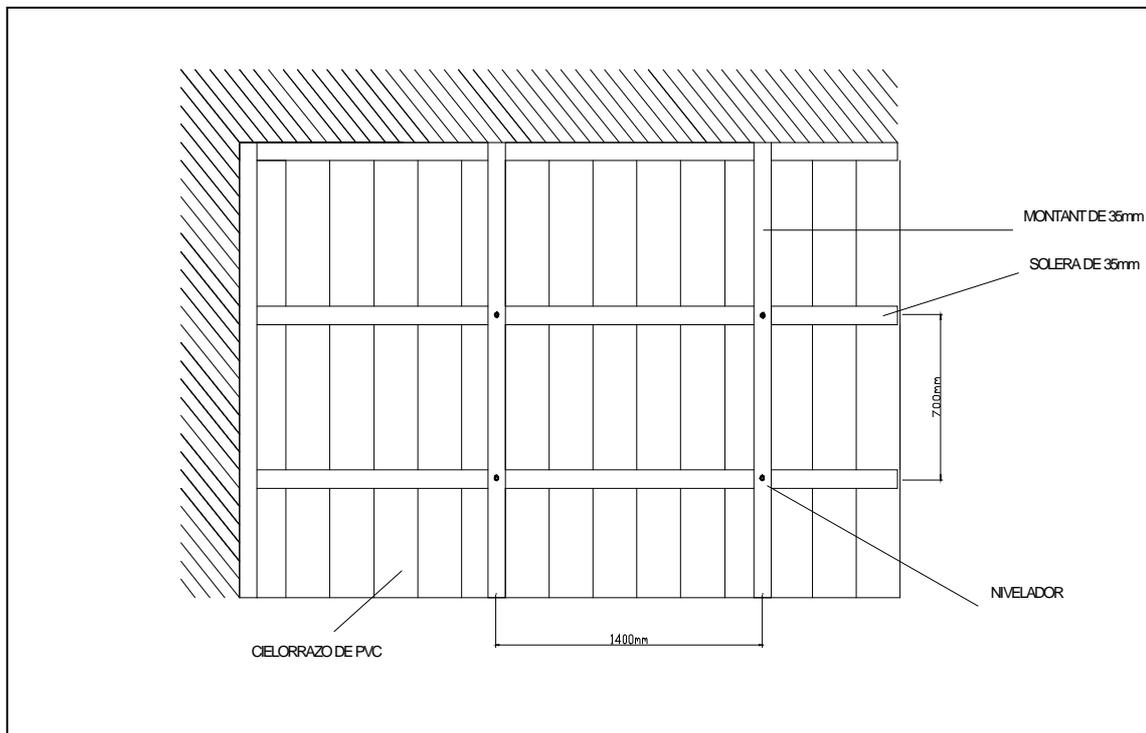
Estructura de sostén suspendida (Vista en planta)
